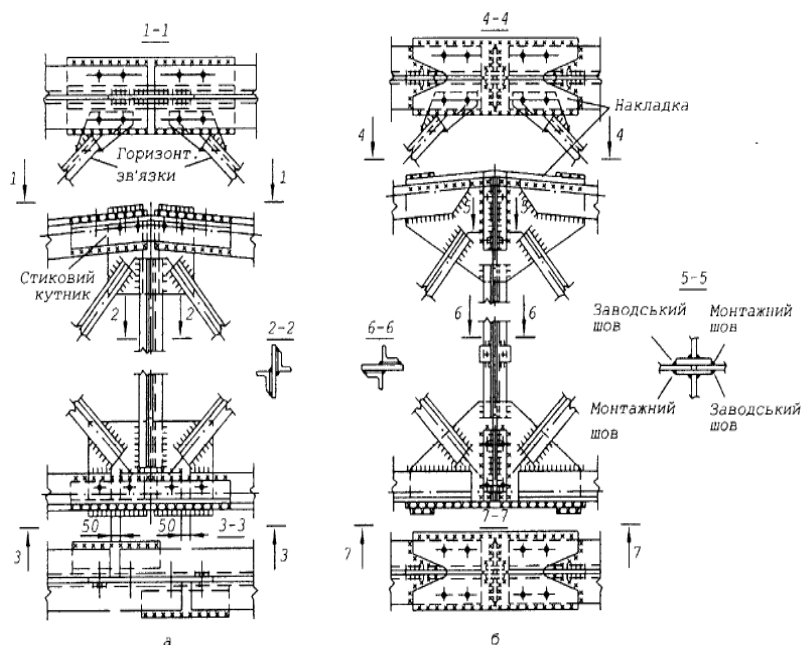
Монтажні стики верхнього та нижнього поясів ферм:
